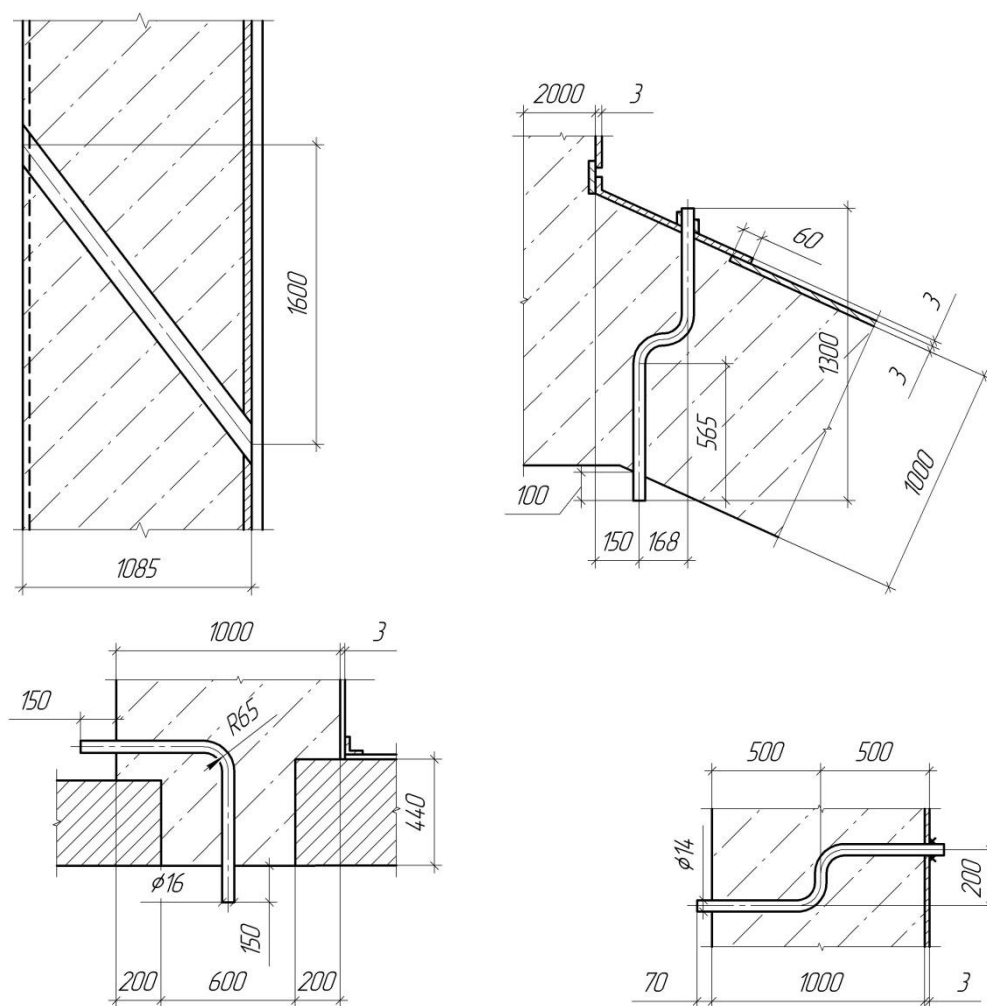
Типы «косых» проходов в стенах и перекрытиях помещений РУ БН-600
